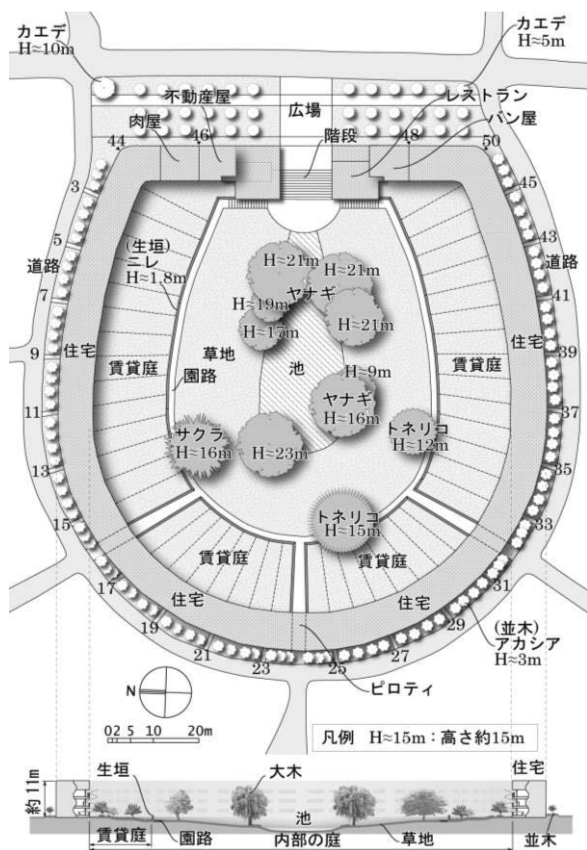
馬蹄形住宅の中庭と樹木の平・断面図
